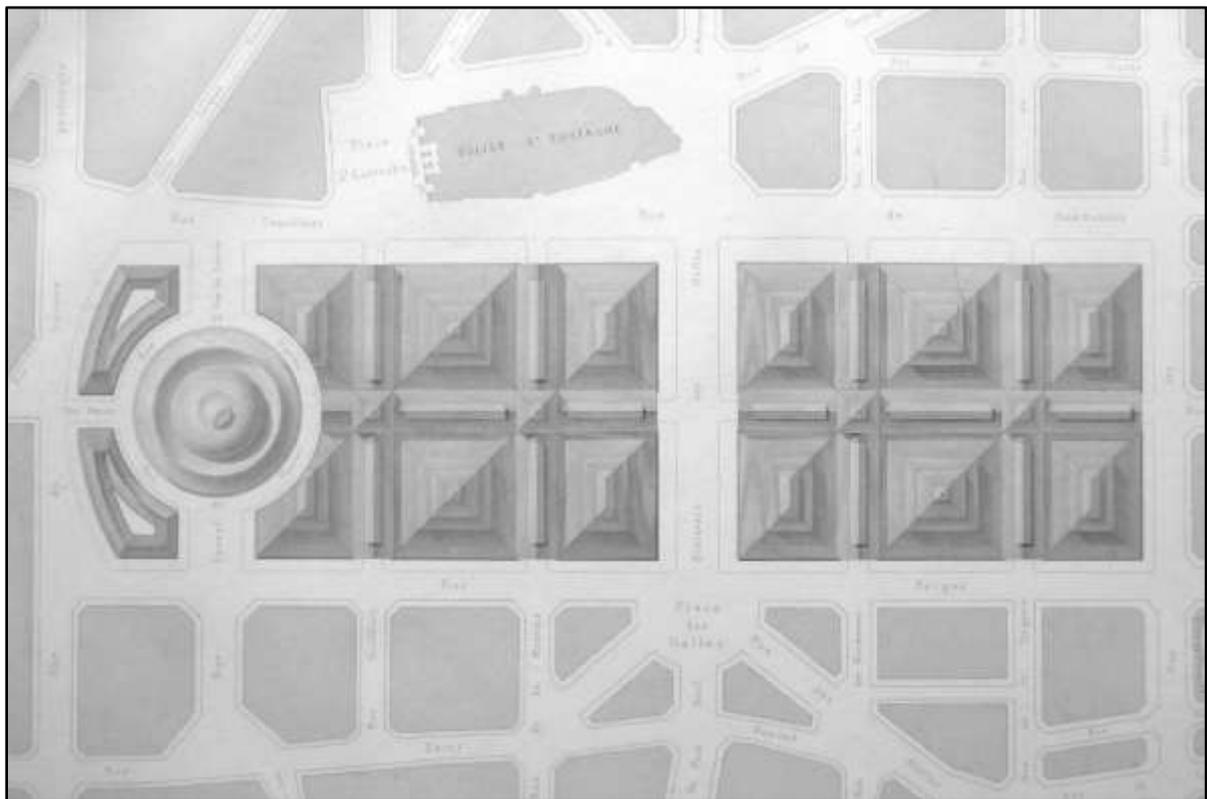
Halles Centrales de Paris. Plan d'ensemble des combles.
